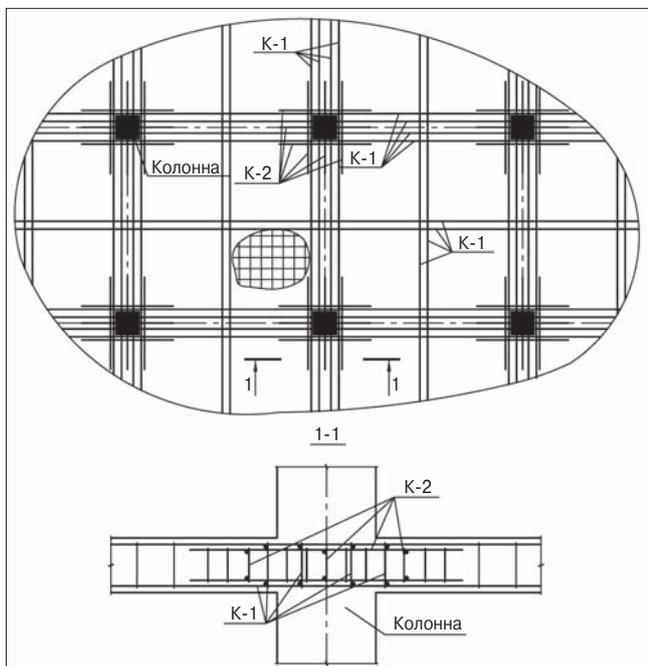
Схема усиления армирования безбалочного бескапитального монолитного перекрытия сварными каркасами: К-1 – пролетный каркас; К-2 – надпорный каркас
